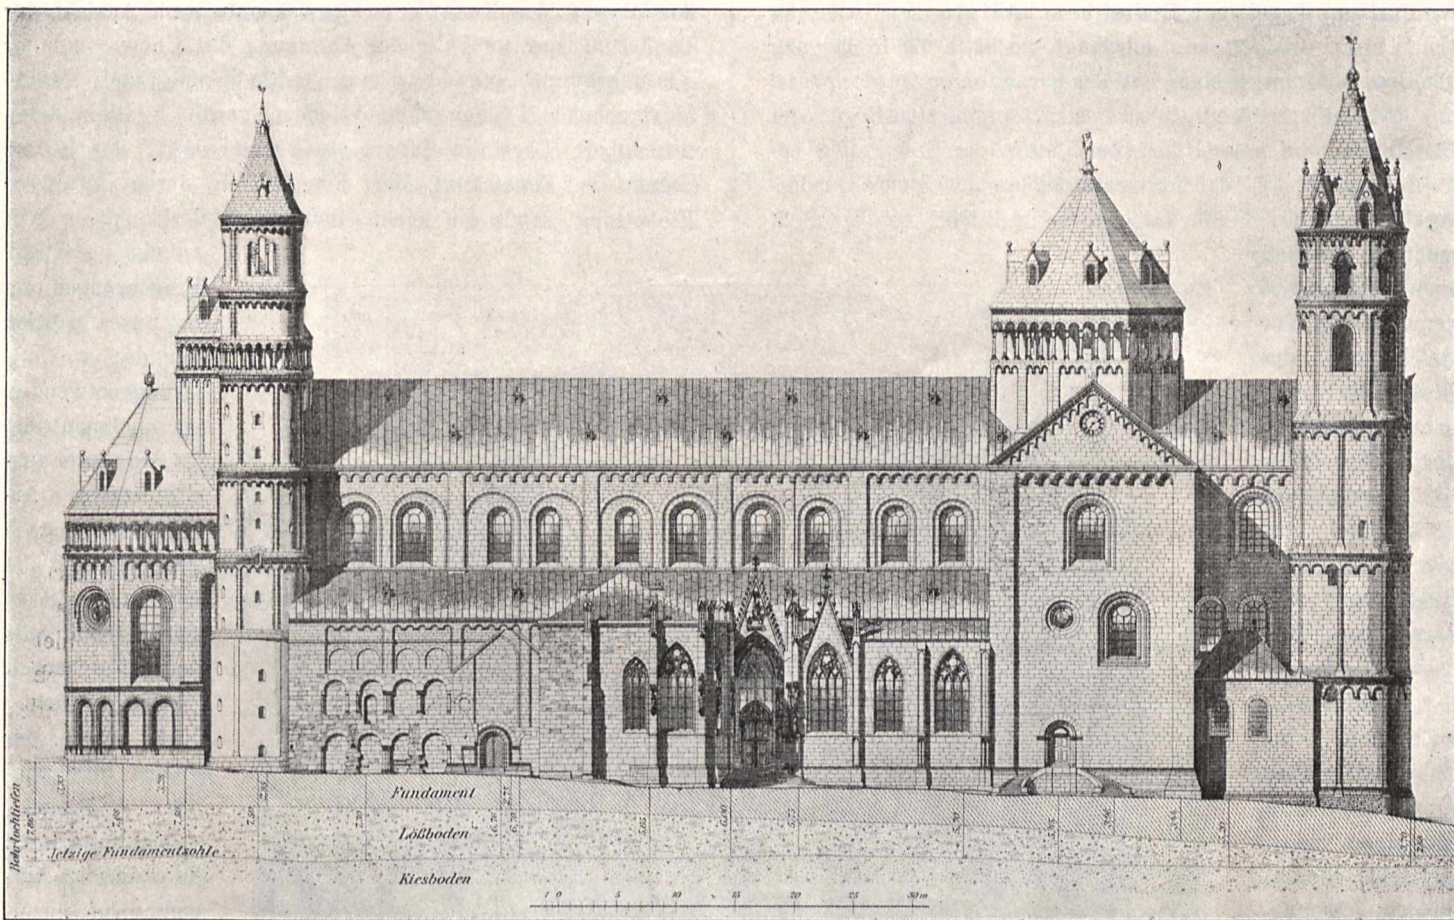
Südansicht des Domes mit Schnitt durch den Untergrund.
